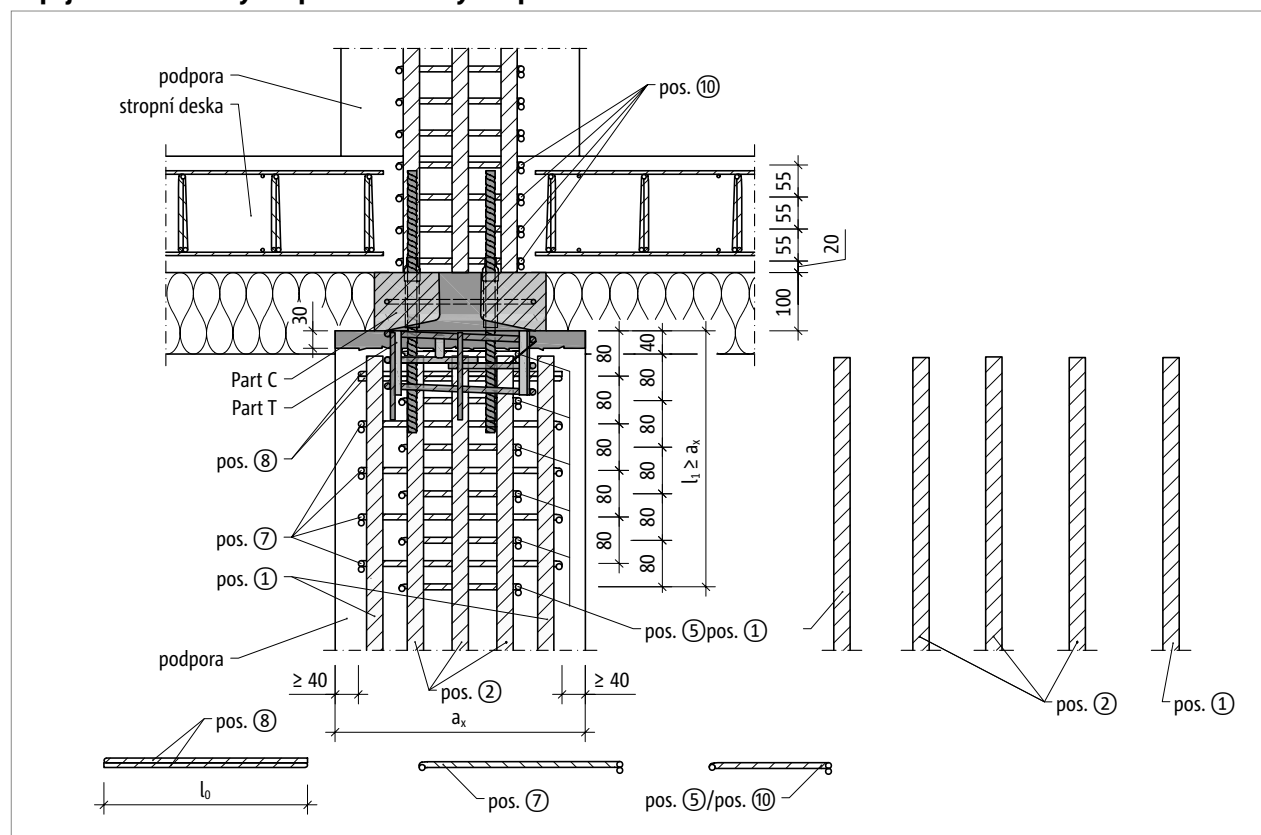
Schöck Scconnex® typ P: Napojovací stavební výztuž v podélném průřezu sloupu A-A
